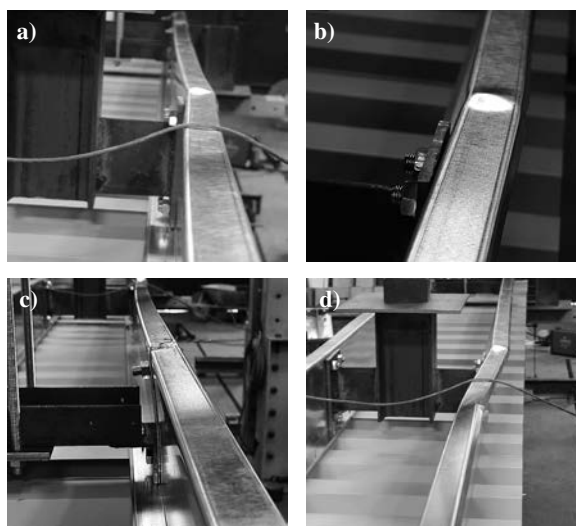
Odvození tvaru vzorku a uspořádání zkoušky
